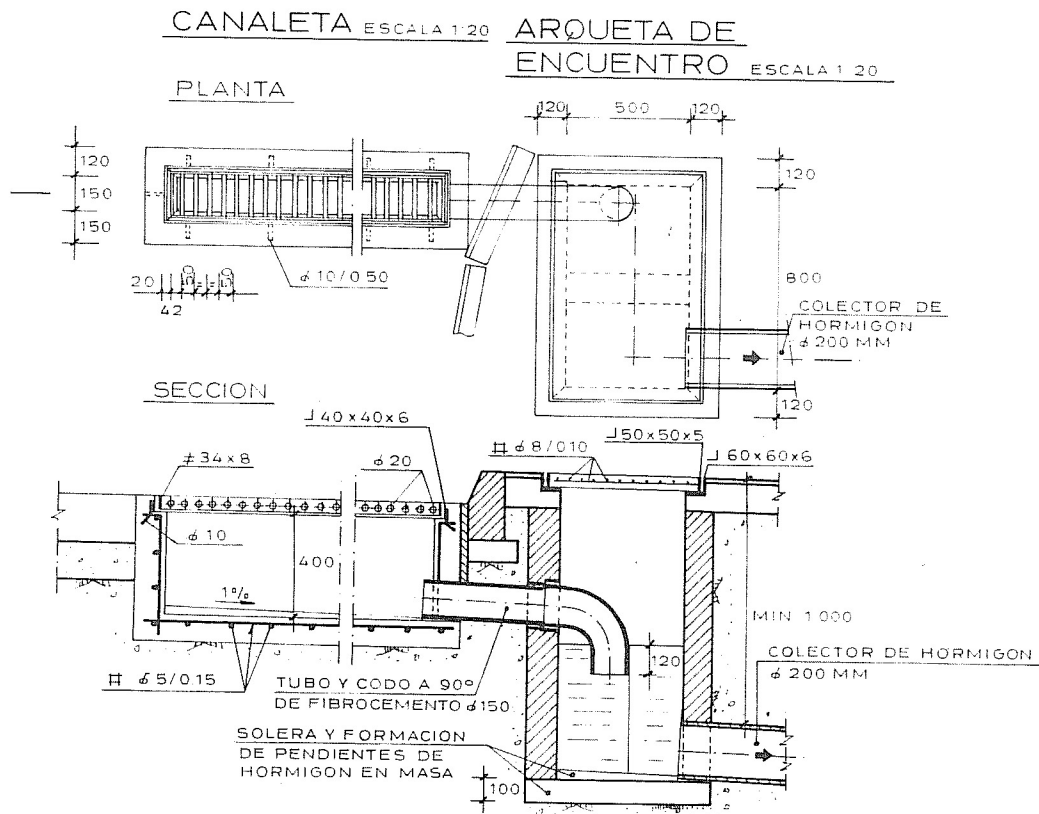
Detalle de construcción de la canaleta de desagüe y la arqueta de encuentro
